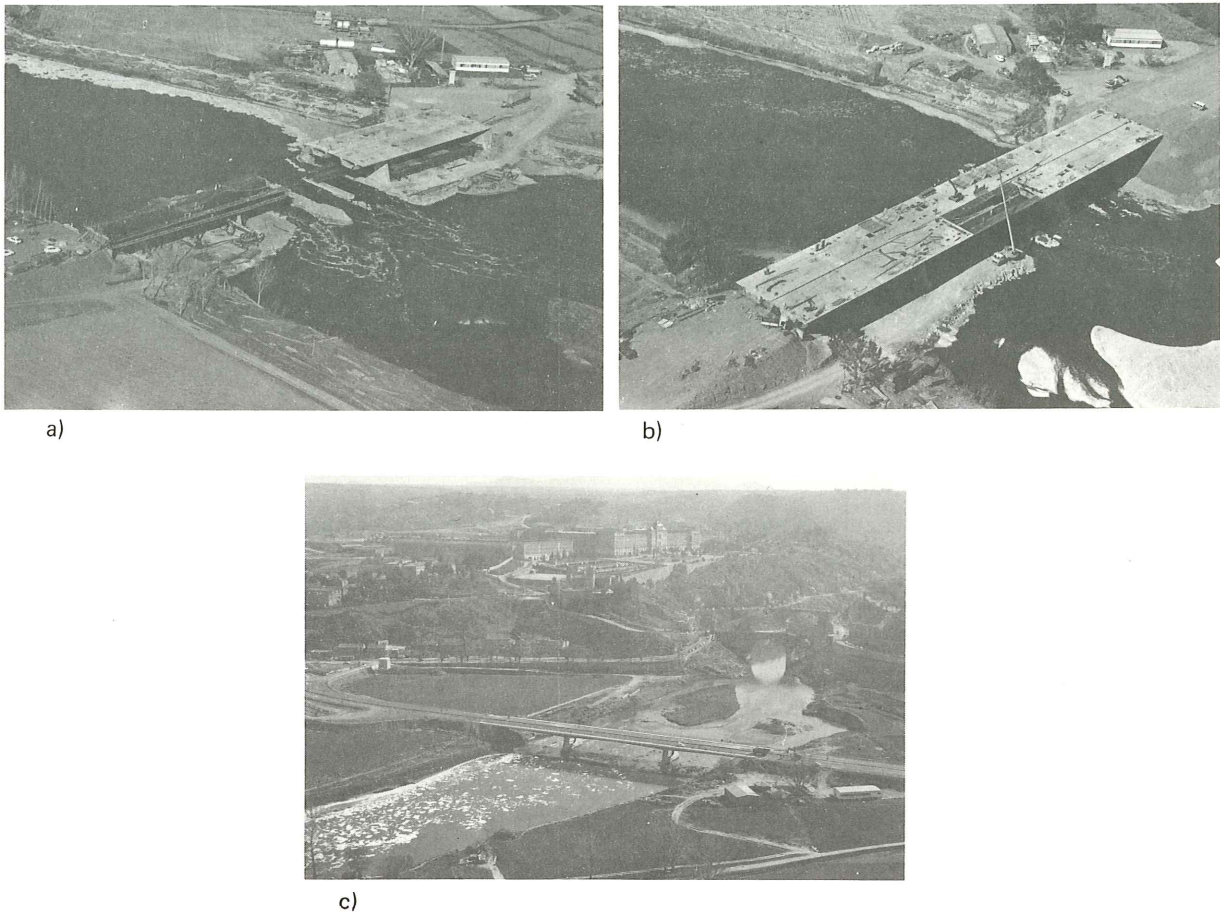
Fases constructivas. a) Primera fase terminada y segunda en construcción. b) Cierre del tramo central en el segundo cajón. c) Puente terminado.
